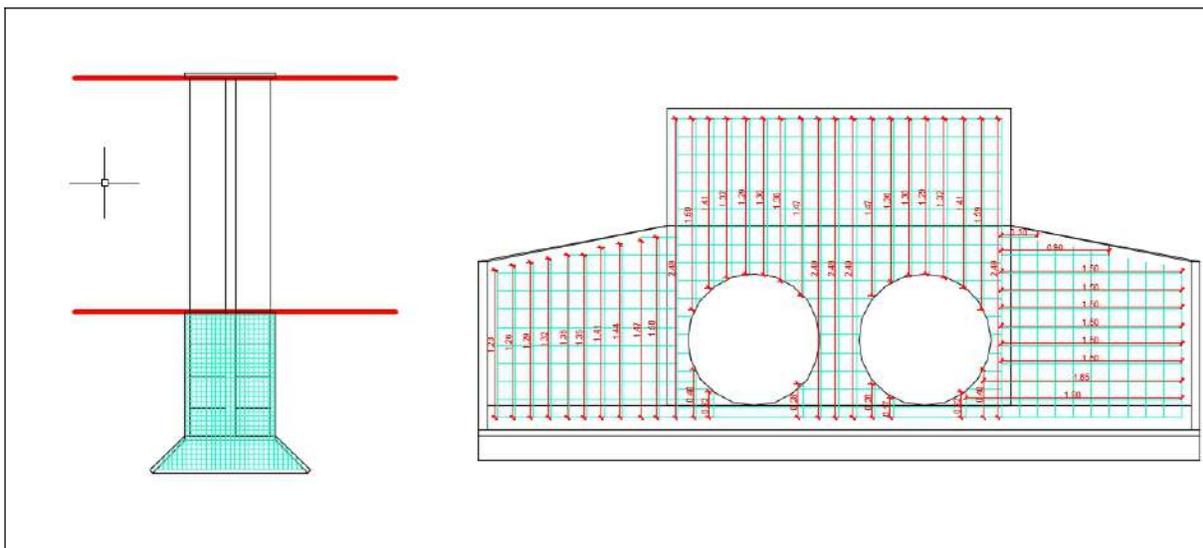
Planos aporte Ingenieril. Fuente (propia)
